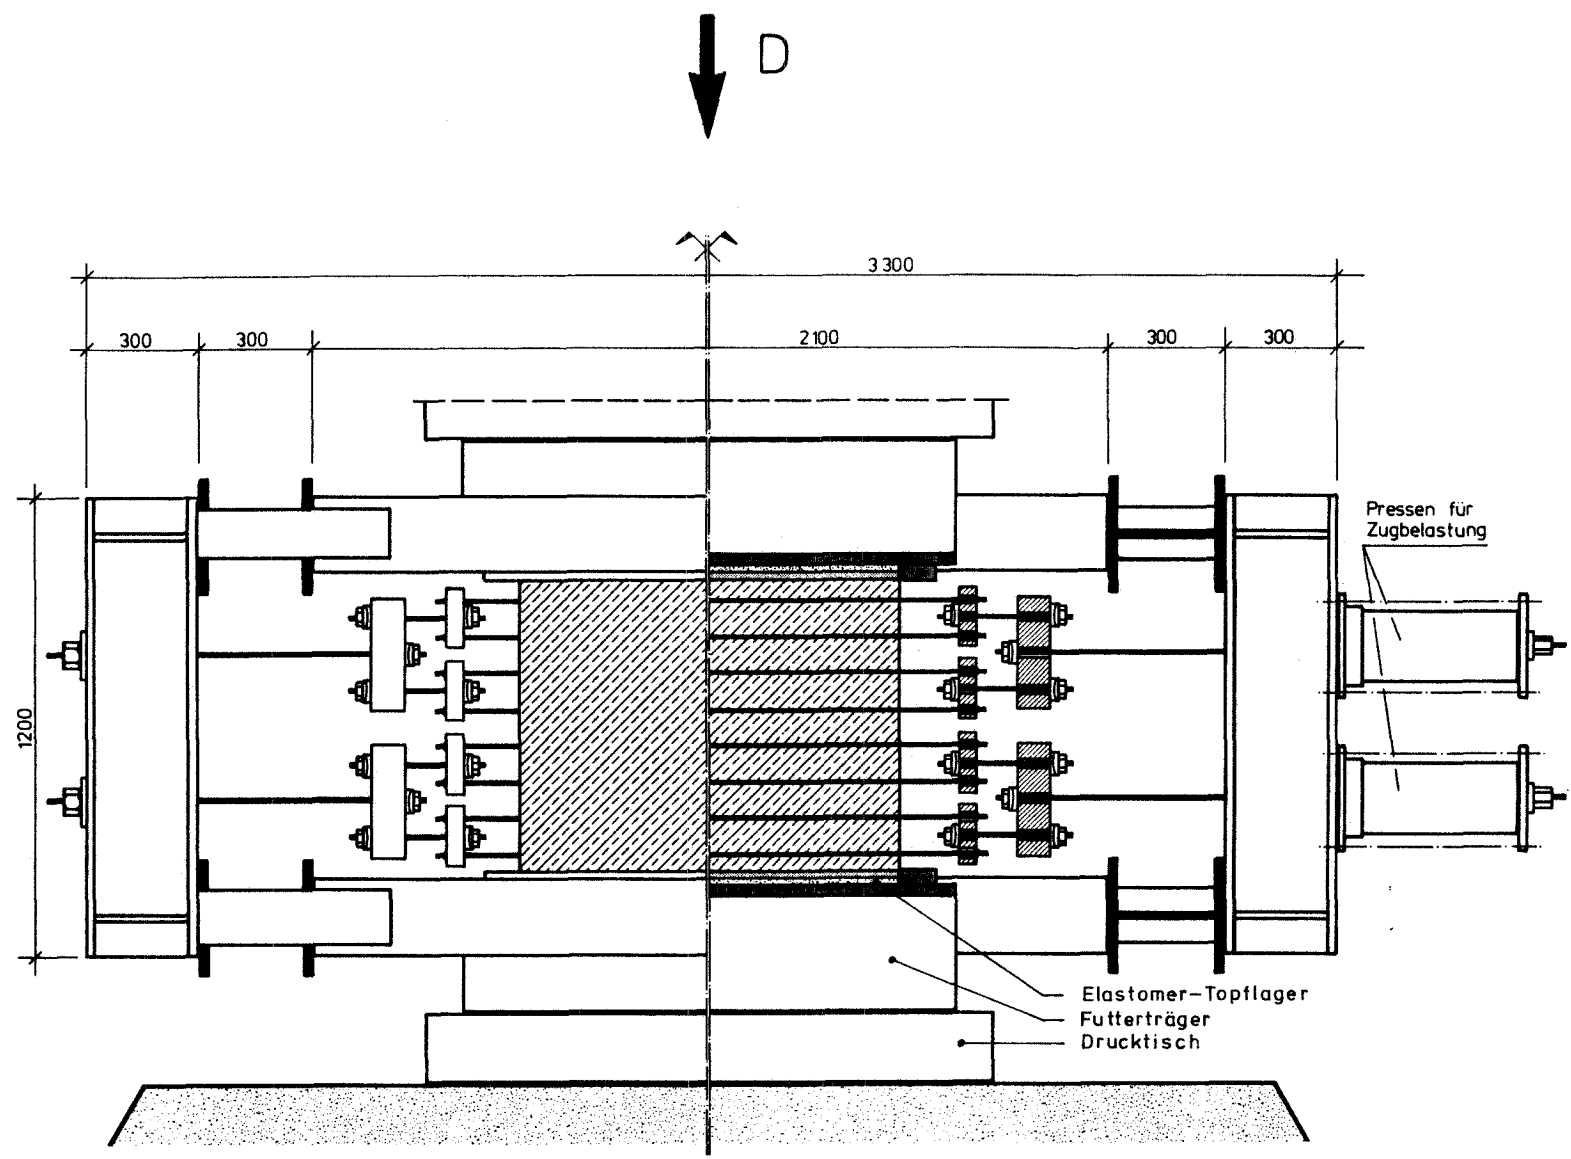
Ansicht/Schnitt des Probenkörpers in der Prüfmaschine
